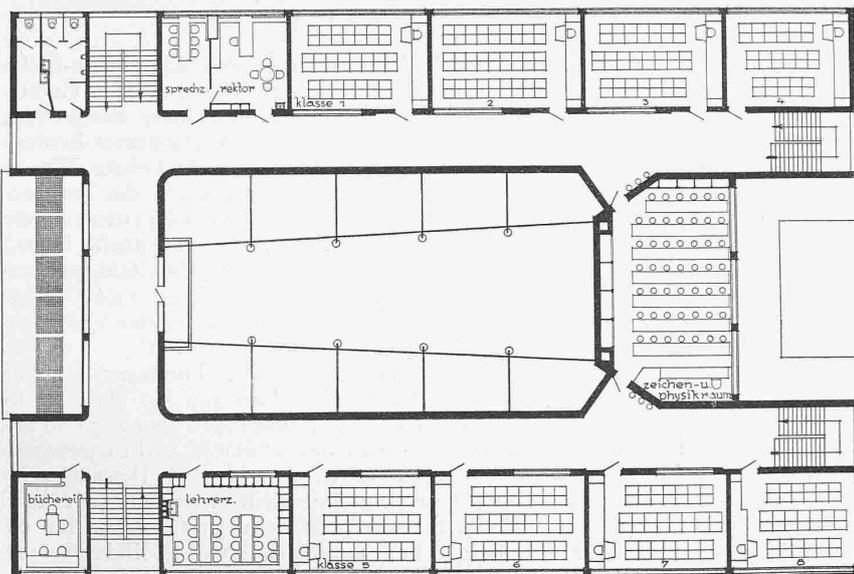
Obergeschoss-Grundriss. — Masstab 1 : 400.
